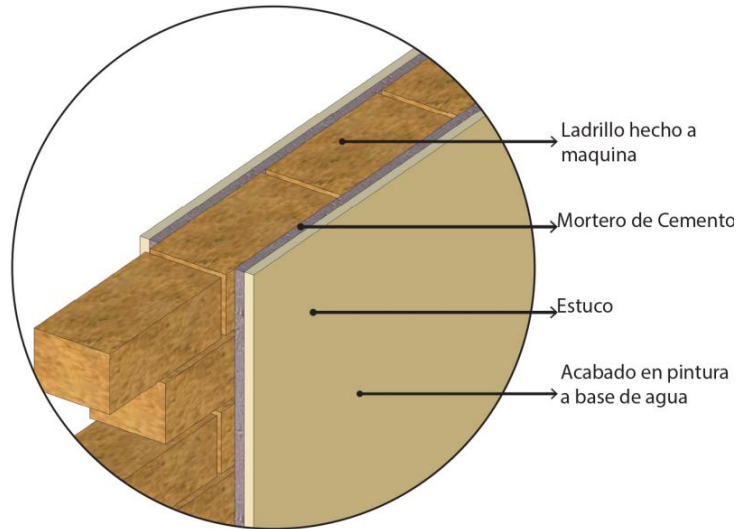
Detalle constructivo típico de un muro de en mampostería de ladrillo Fuente: elaboración propia
